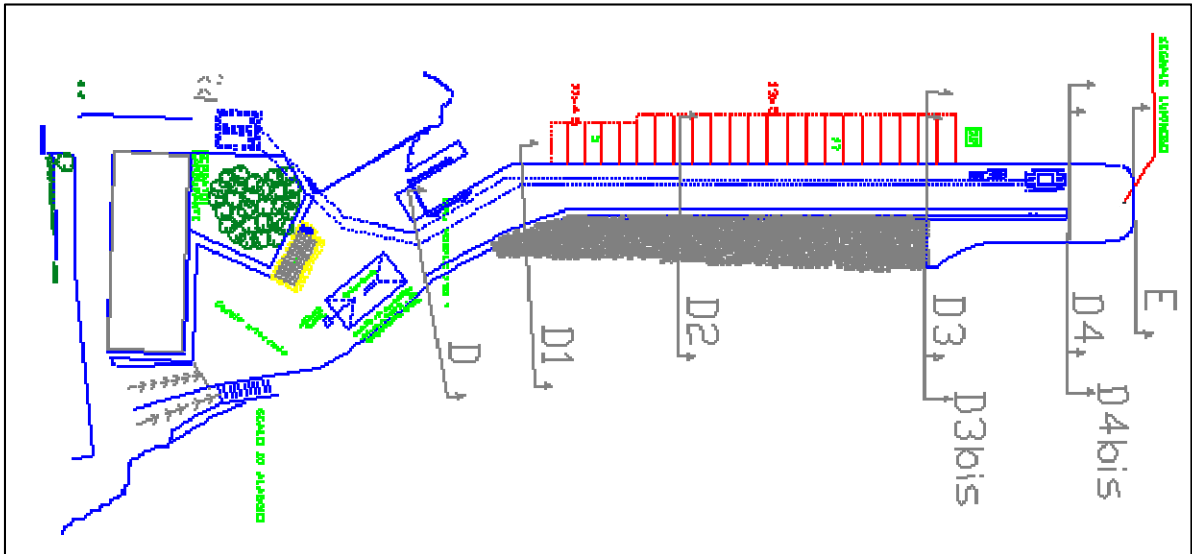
planimetria del nuovo molo di sottoflutto
